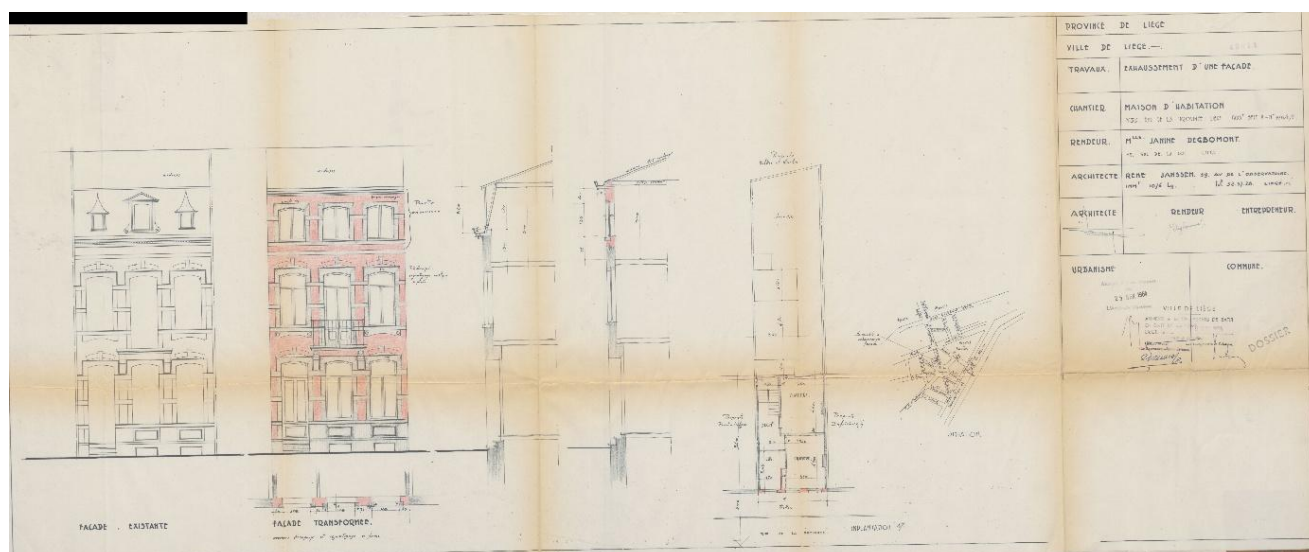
Élévation des travaux effectués en 1964 pour l'exhaussement de la façade principale
